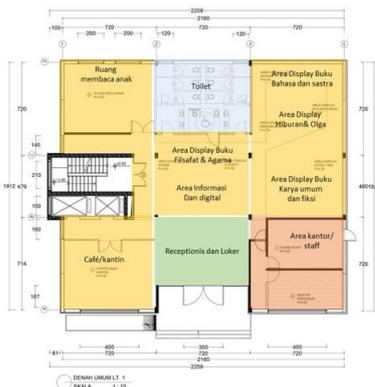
Denah Eksisting Perpustakaan Umum Bekasi
